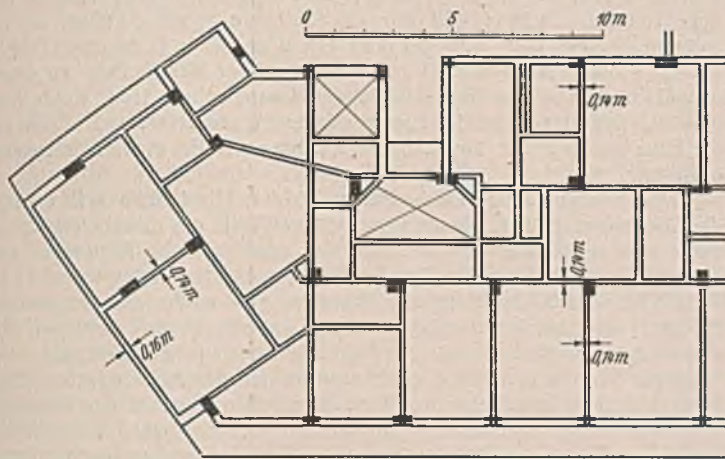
Verteilung der Säulen und Balken bei einem Bukarester siebenstöckigen Eisenbetonfachwerkgebäude.
